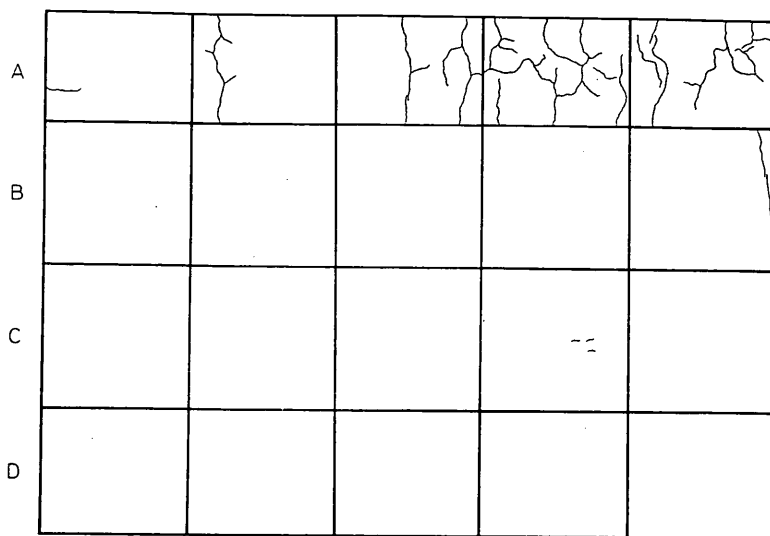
ひびわれ調査図（施工後2.5ヶ月）
